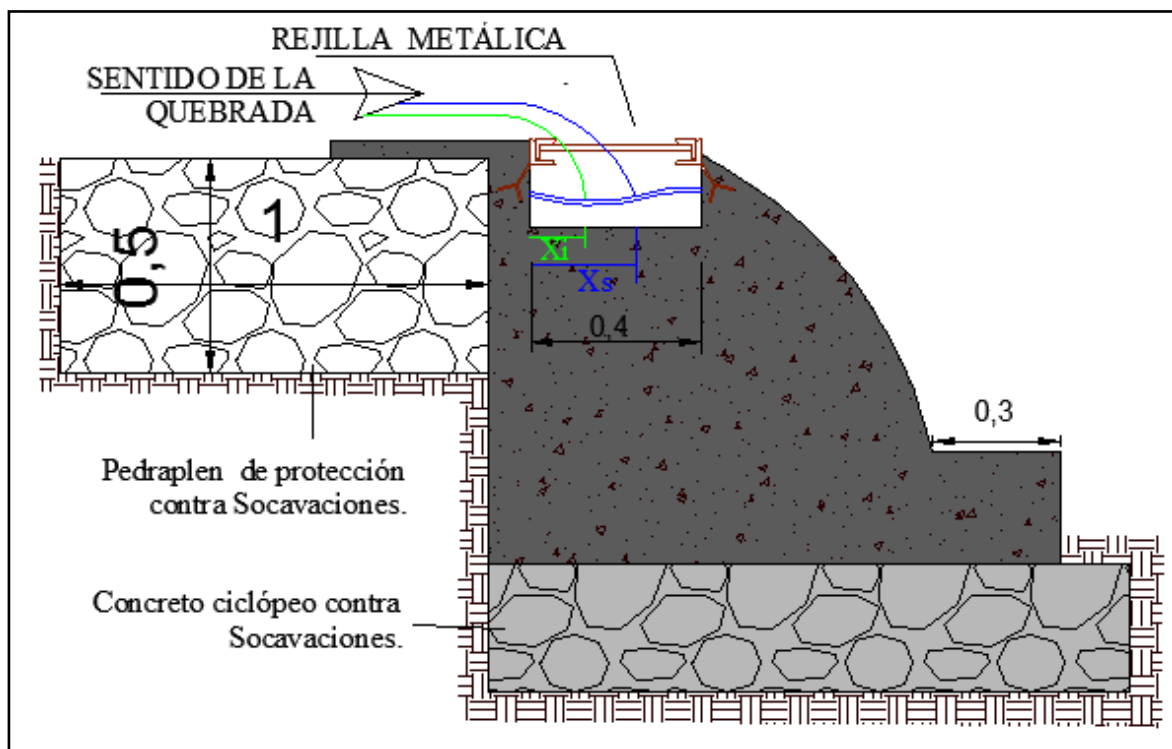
Sección transversal de la presa y canal de aducción. Fuente: Autores del proyecto.
